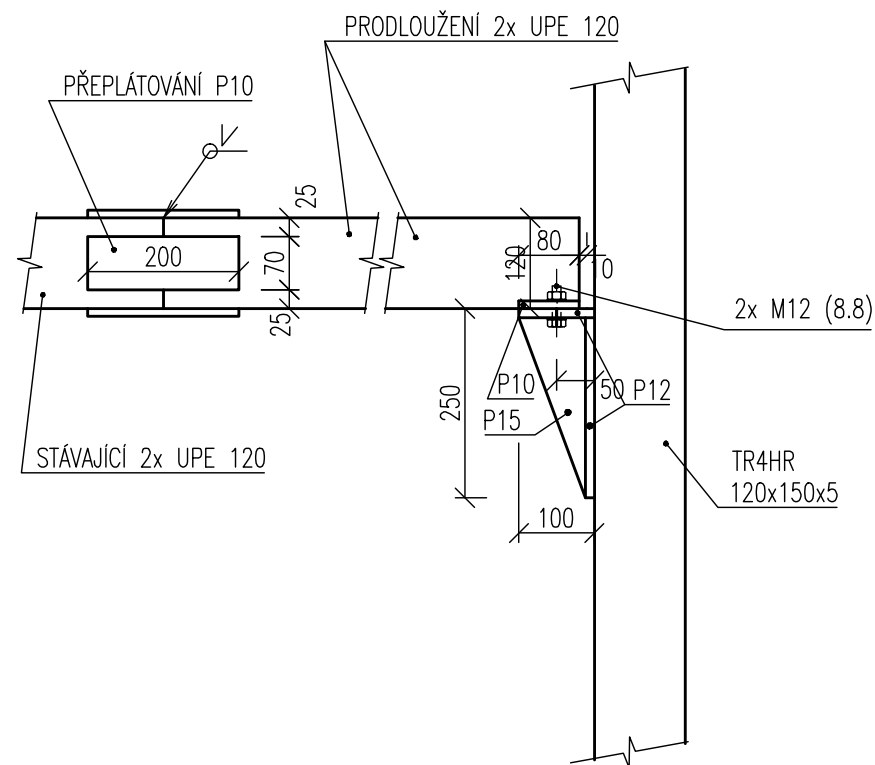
PŘIPOJENÍ NOSNÍKŮ K BETONOVÝM SLOUPŮM
